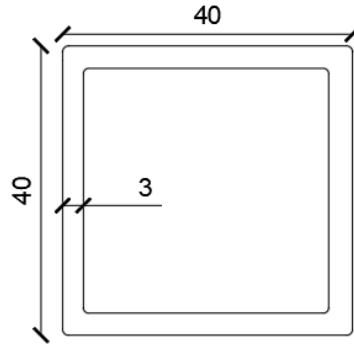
Características de la diagonal más crítica, diseño final de la estructura de acero.
